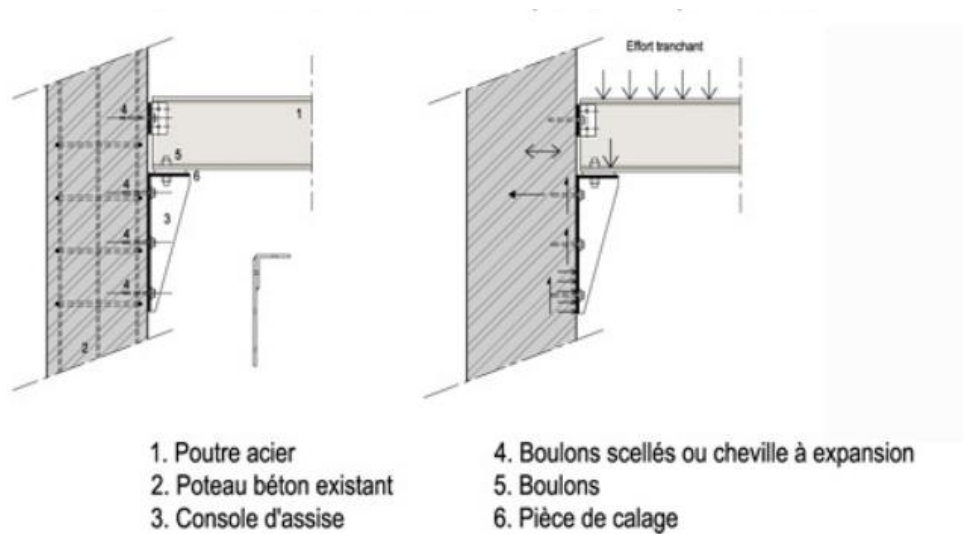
Schéma d'un détail d'attache d'une poutre métallique sur un poteau existant
